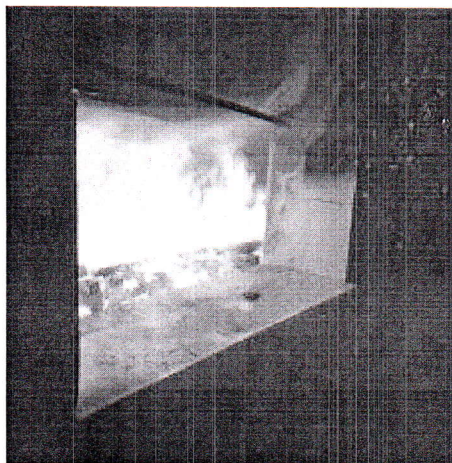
Б. Фрагмент образца фасада при испытании по ГОСТ 31251-2008.
